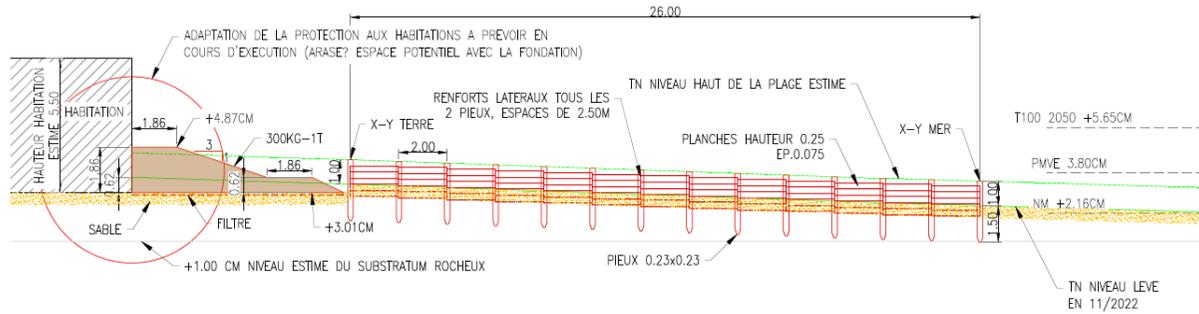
DETAIL GANIVELLES ET PIQUET D'ANCRAGE ECHELLE:1/50
